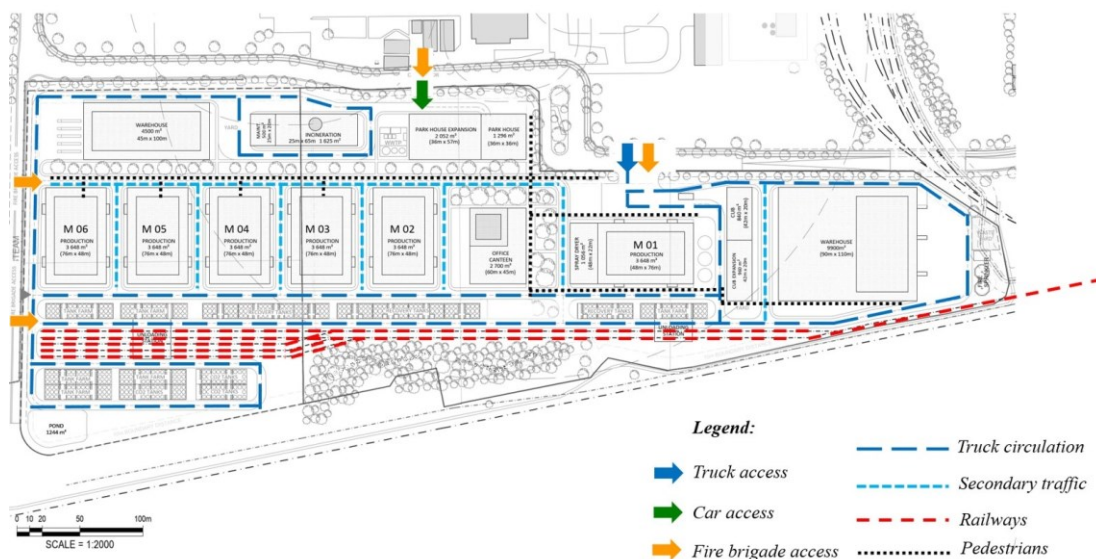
Auszug Site Masterplan, Schema Erschliessung (Bachem AG, Stand 12.12.2024)
